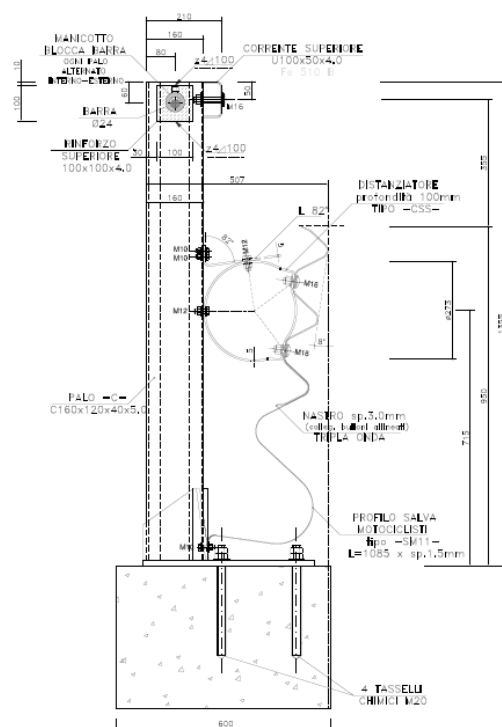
Schema tipo barriera ANAS bordo ponte H2
